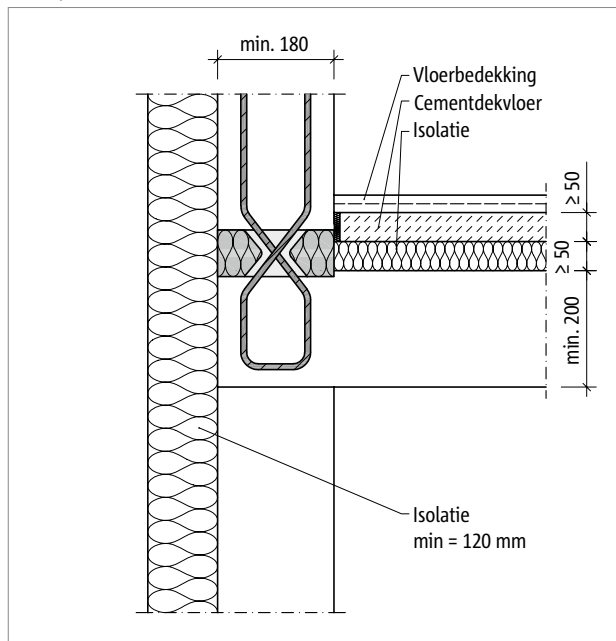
Schöck Sconnex® type W-N-VH: Met brandwerende strip van steenwol ter hoogte van de rand van de dekvloer
